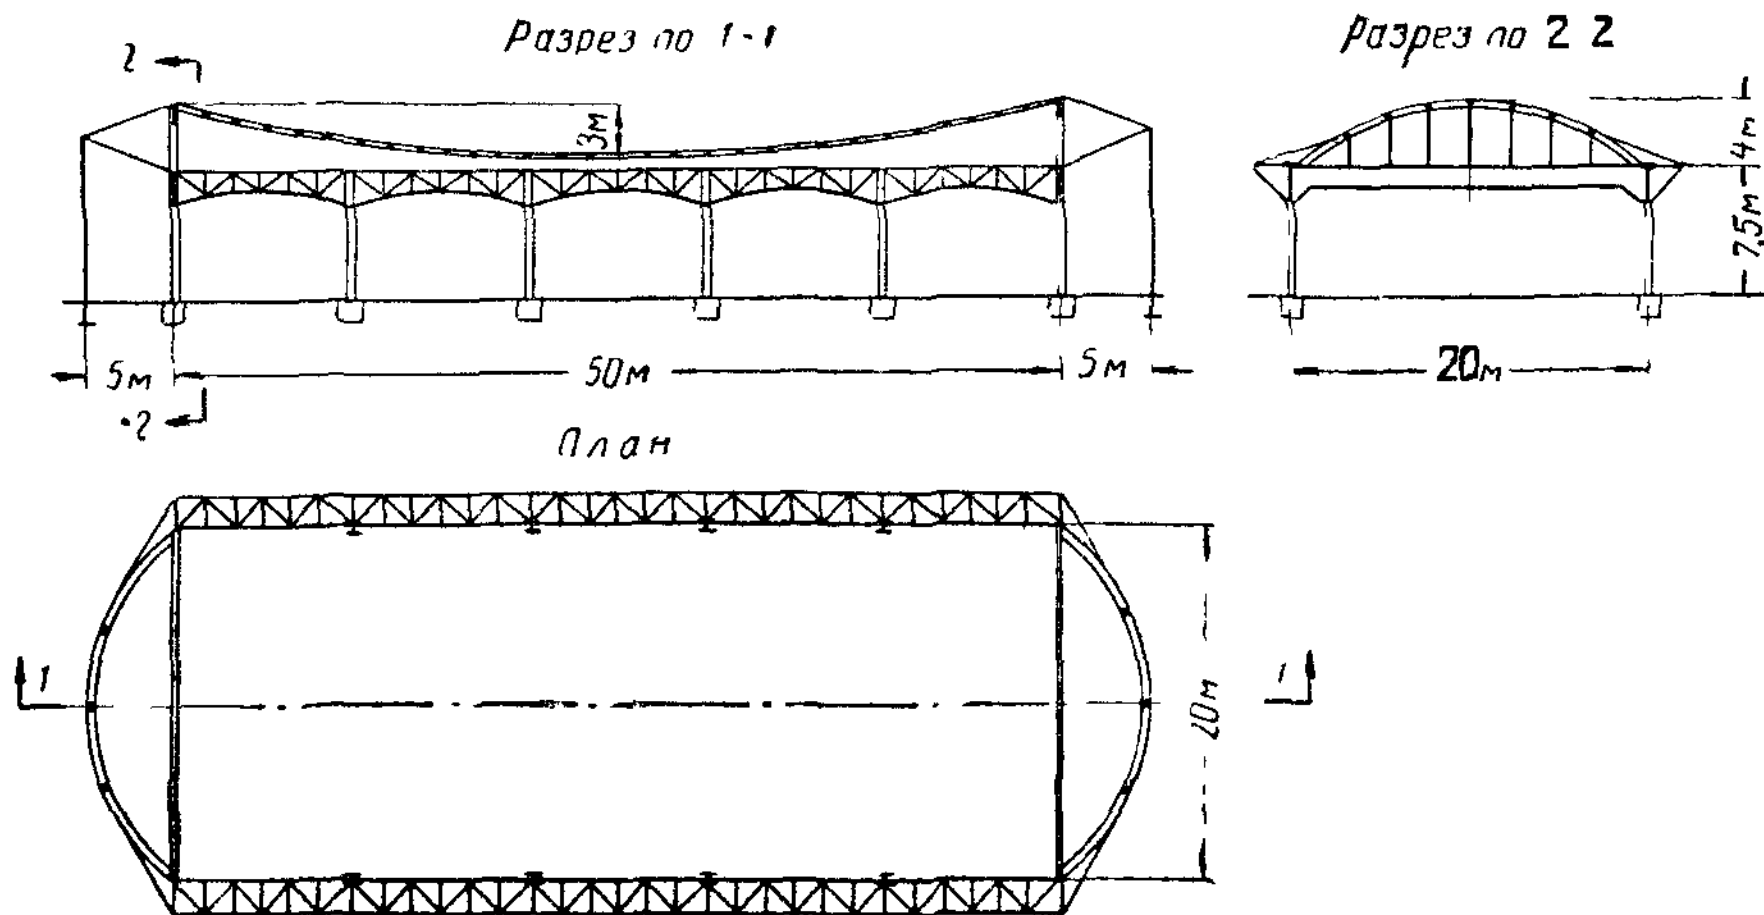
Конструкция легкого павильона (прямоугольного в плане)
